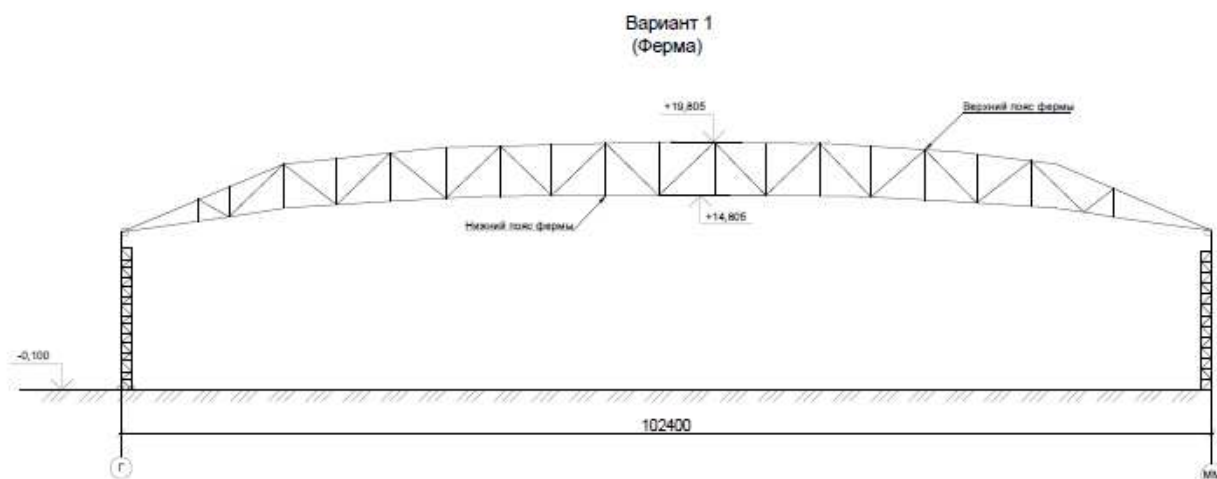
Вариант конструкции покрытия (ферма)
